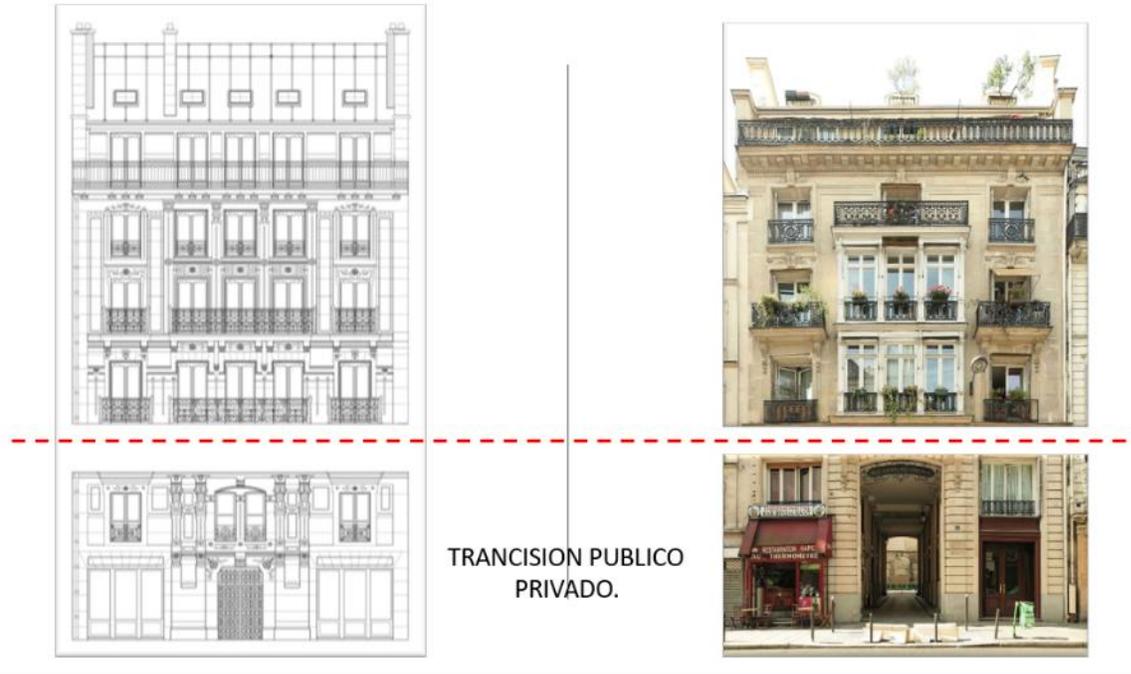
Esquema arquitectónico adaptado en edificaciones aledañas al bulevar Haussmann. Trabajo propio basado en (LAN, 2017)
